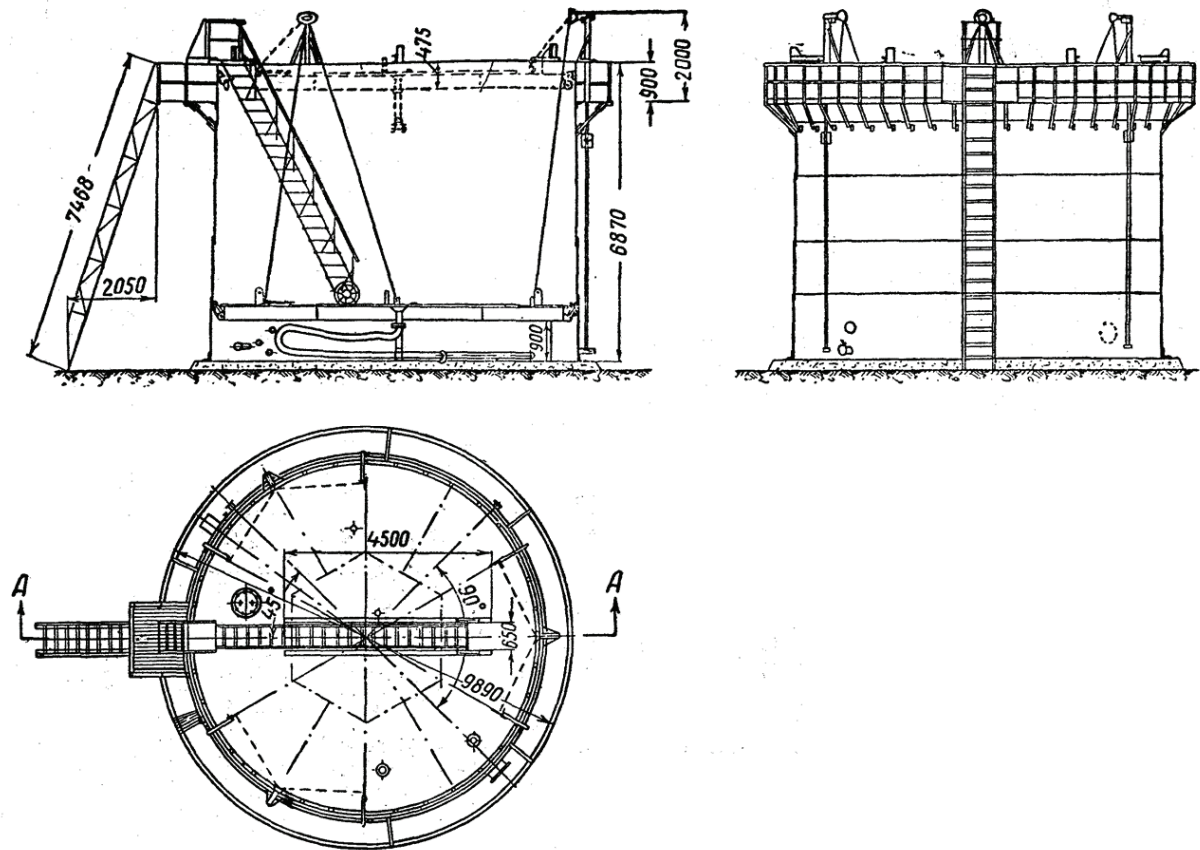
Общий вид построенного резервуара с плавающей крышей
